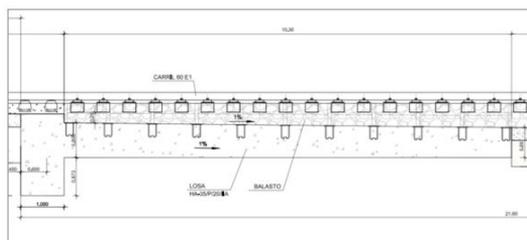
Losa de hormigón en zona de transición placa-balasto,(FUENTE: Instrucción general para la redacción de proyectos de vía IGV-2011 [10]. IGV-1.15 Interacción vía-estructura)
